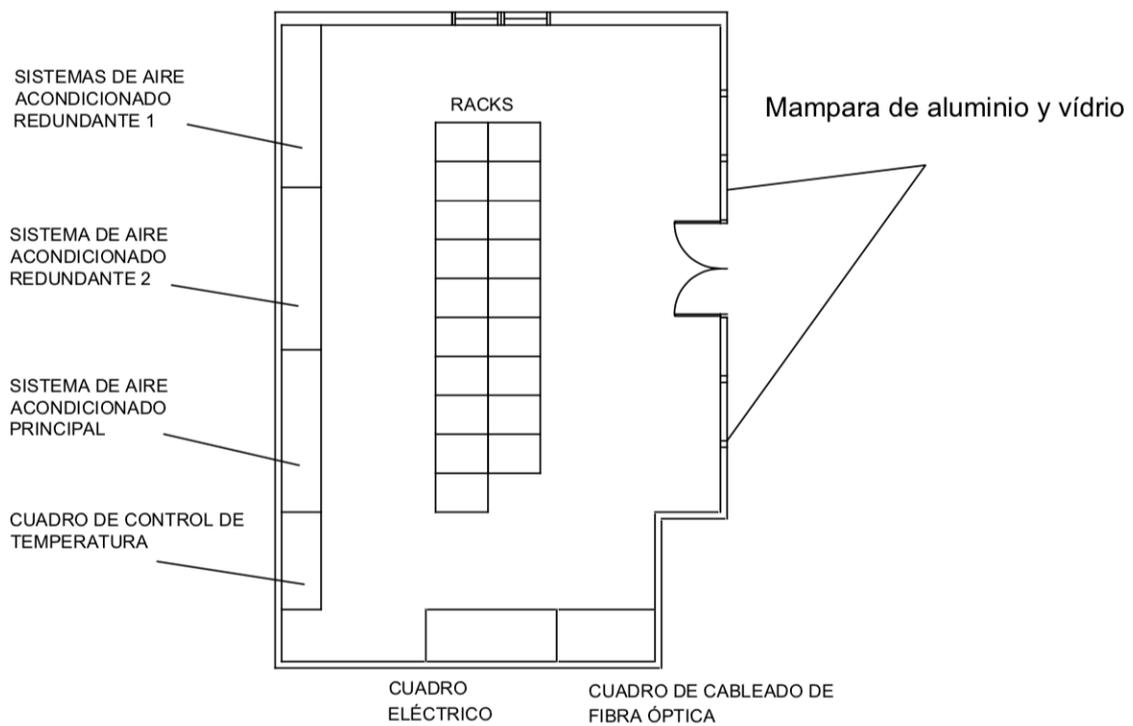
Plano de planta de la sala CPD con la distribución de los equipos.
